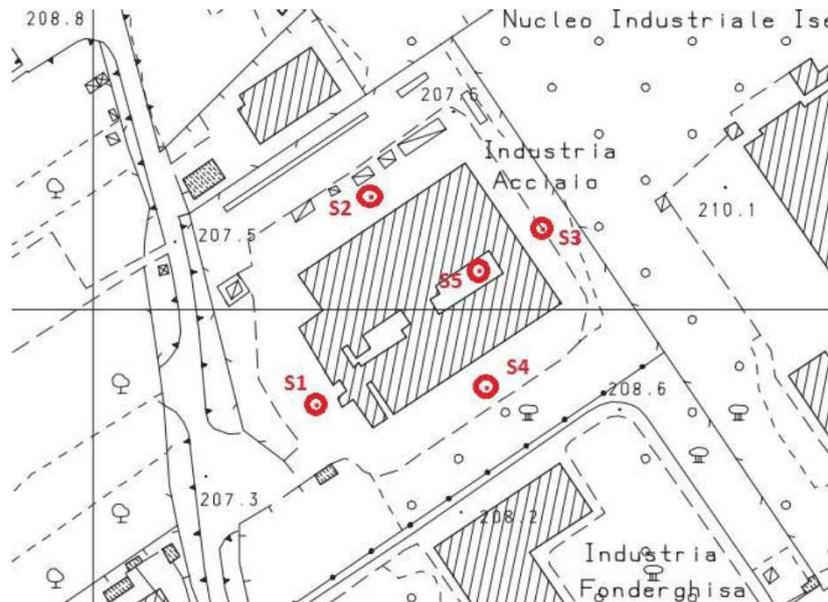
Localizzazione planimetrica dei sondaggi eseguiti presso il sito oggetto di intervento [Estratto dall'allegato RS_GEO]
